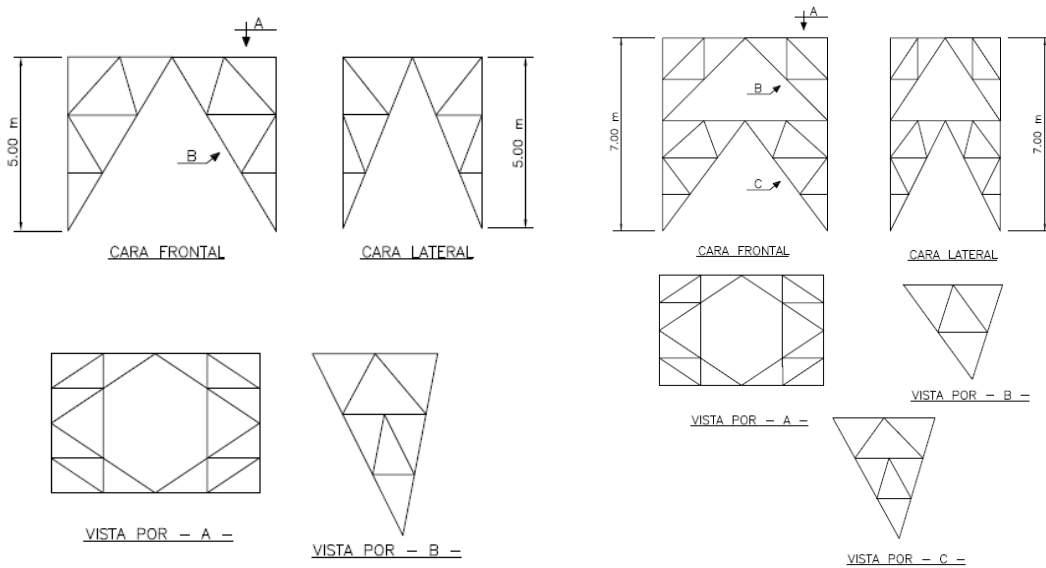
Detalles constructivos del recrecido de los apoyos (recrecido de 5 y 7 m). Fuente: Red Eléctrica
